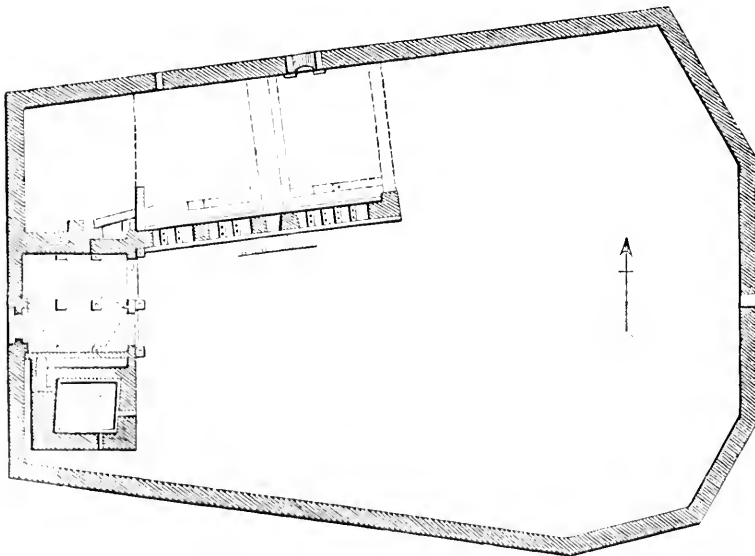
Grundriss des Schlosses zu Gehhausen.
